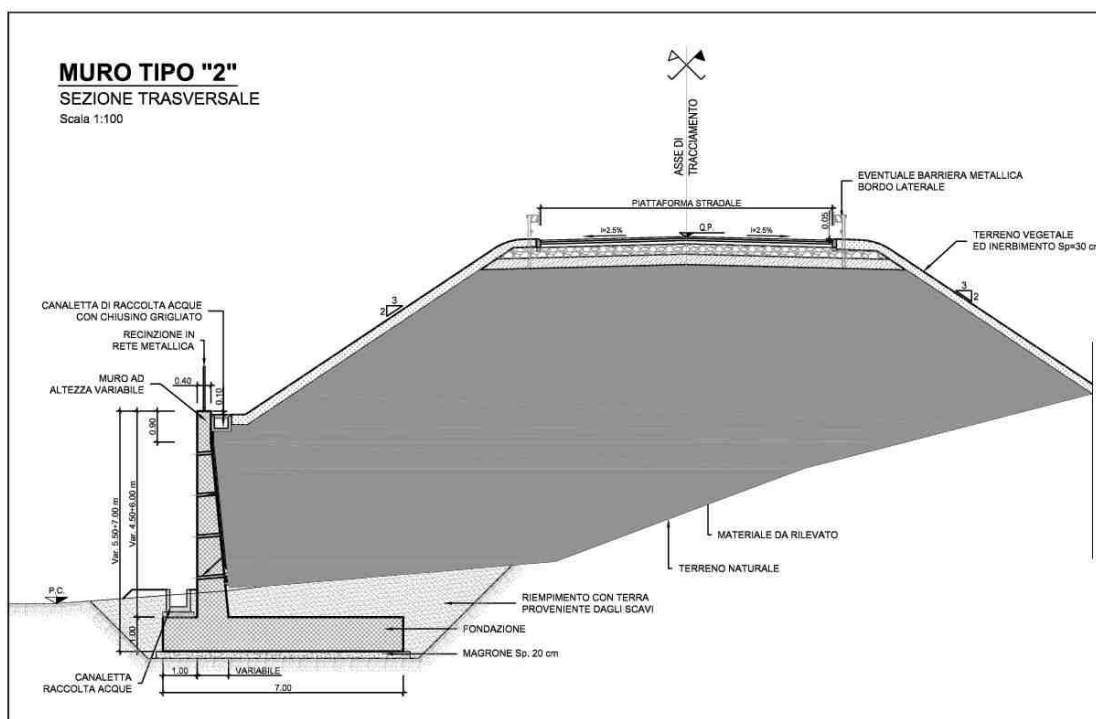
NV93: Muro di sottoscarpa MU19A- Sezione. TIPO 2
